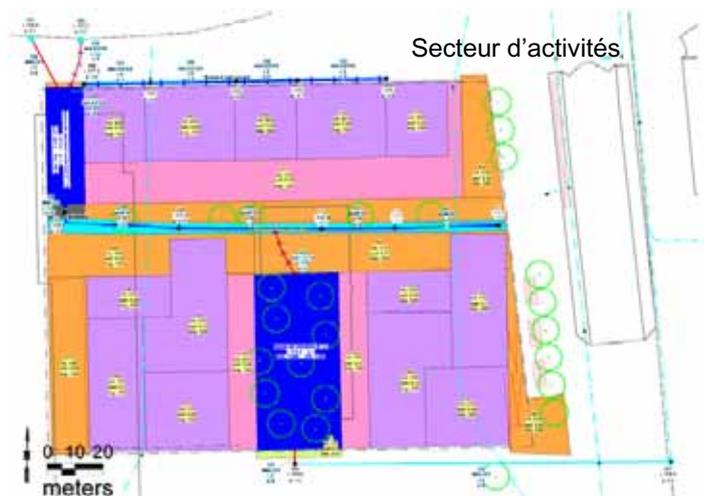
Extrait du plan général de la SOVALP [Plan No:1]
